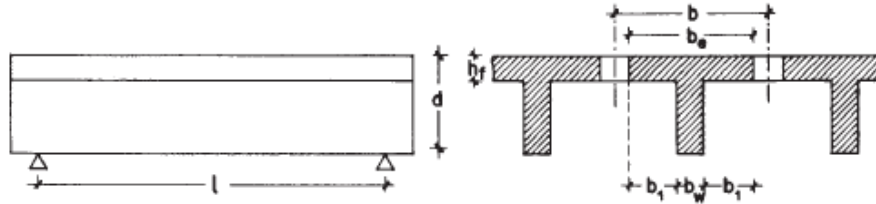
Anchura eficaz del ala en vigas en T múltiples
